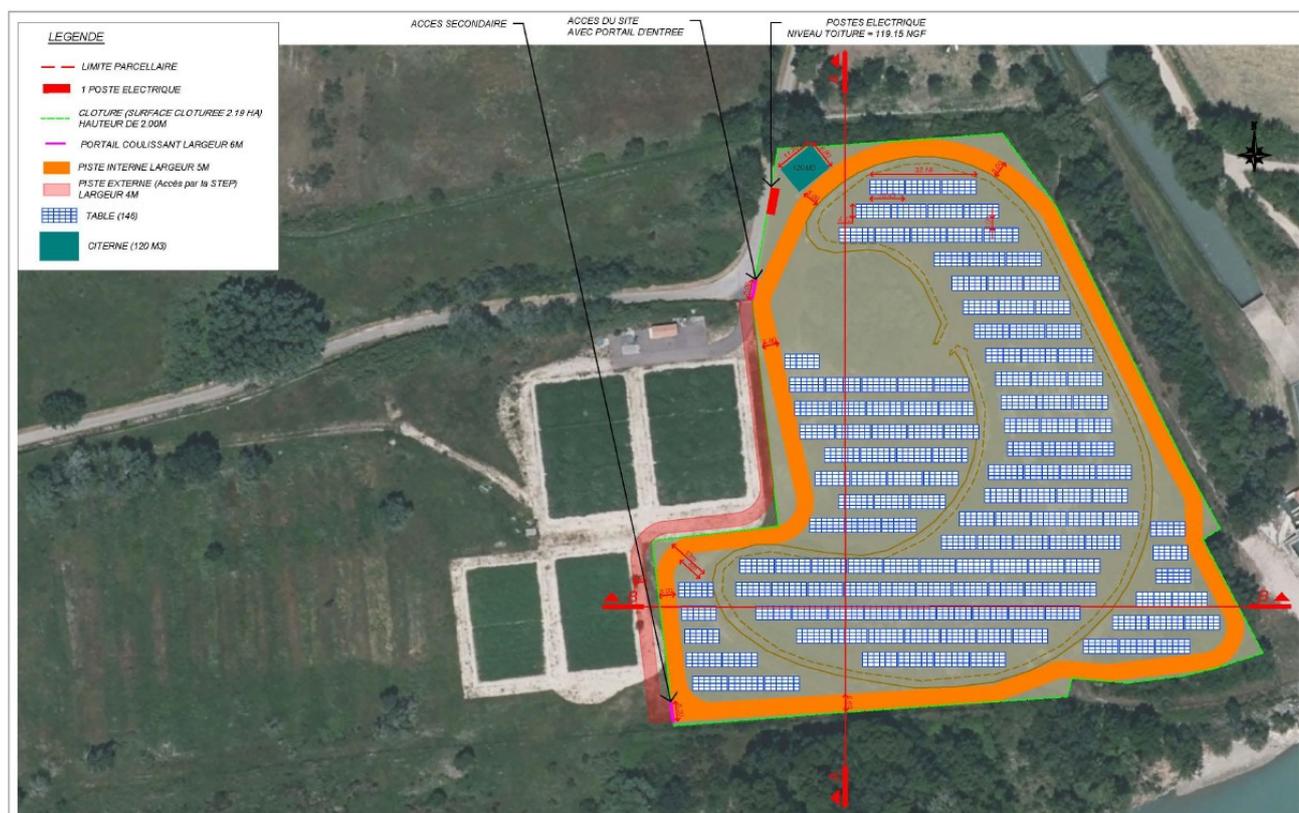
Plan de masse du projet. Source: Étude d'impact.
